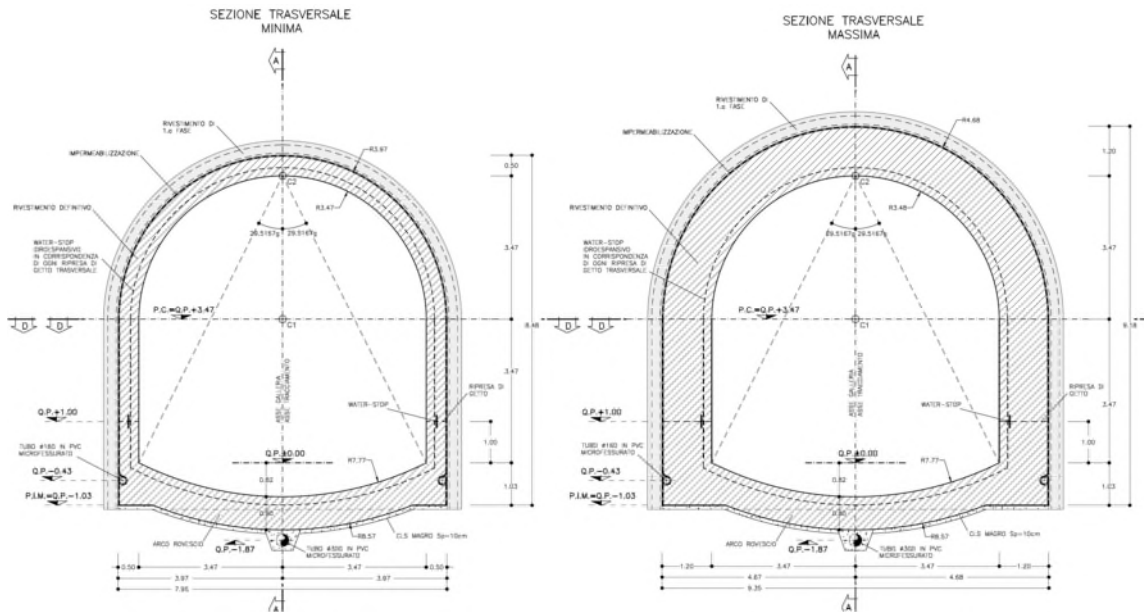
Sezione Tipo C2V – Carpenteria – Sezioni
